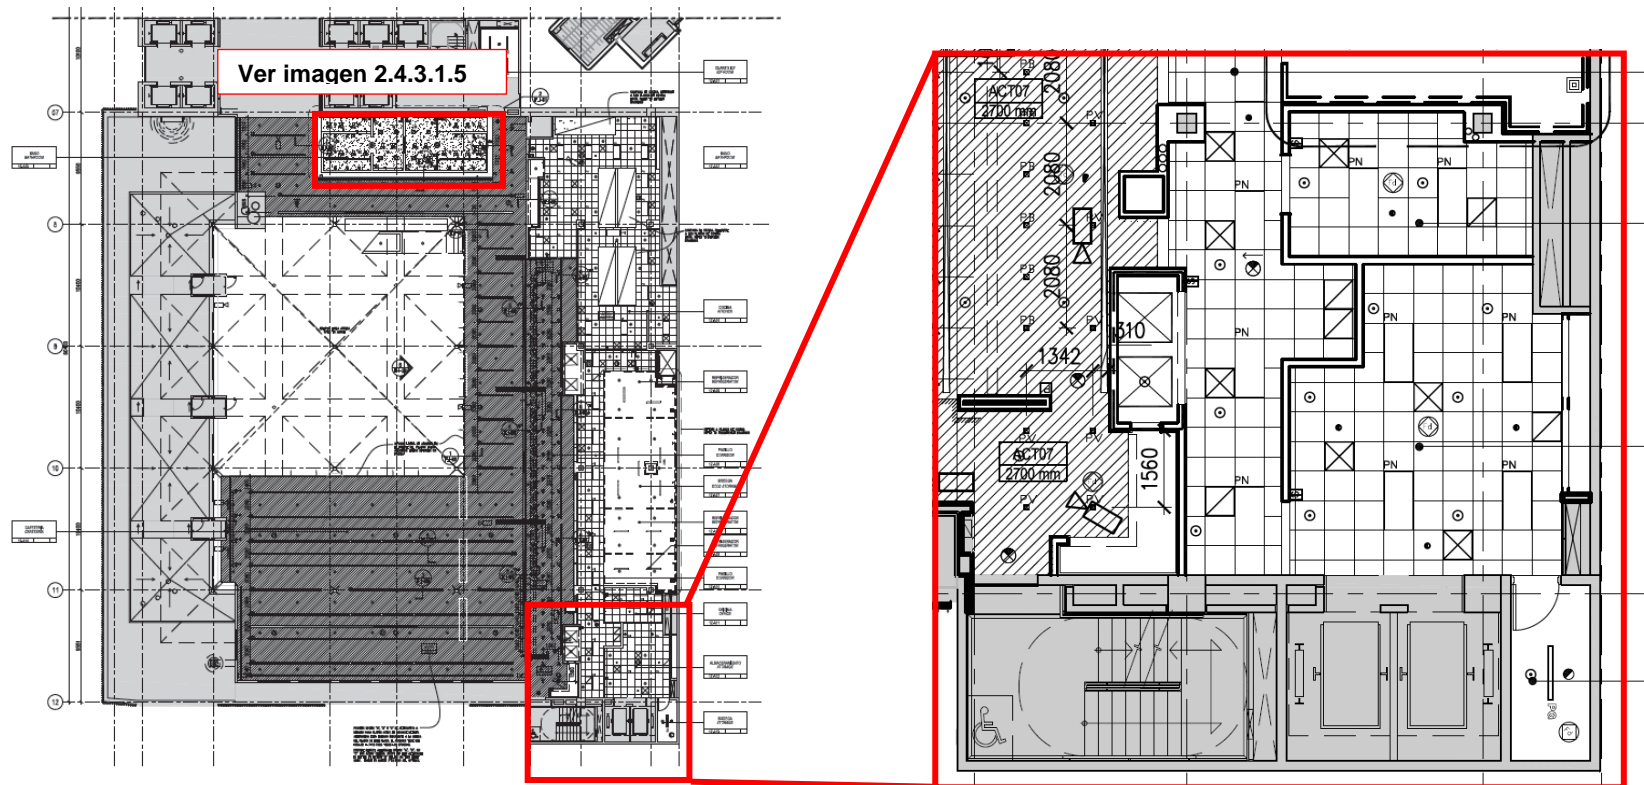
Fragmento plano TF-I-412A, nivel 12 anexo, tomado del set de planos de fit Out BBVA Bancomer, Copyright© 2014 Skimore, Owings & Merrill LLP.
